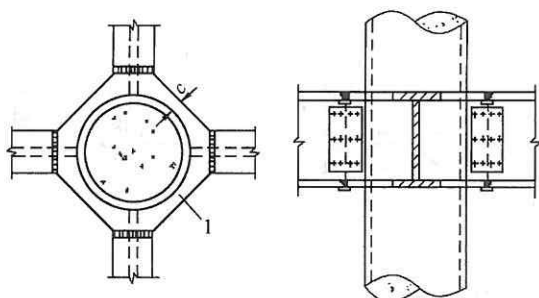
钢梁与钢管混凝土柱采用外加强环连接构造示意图
